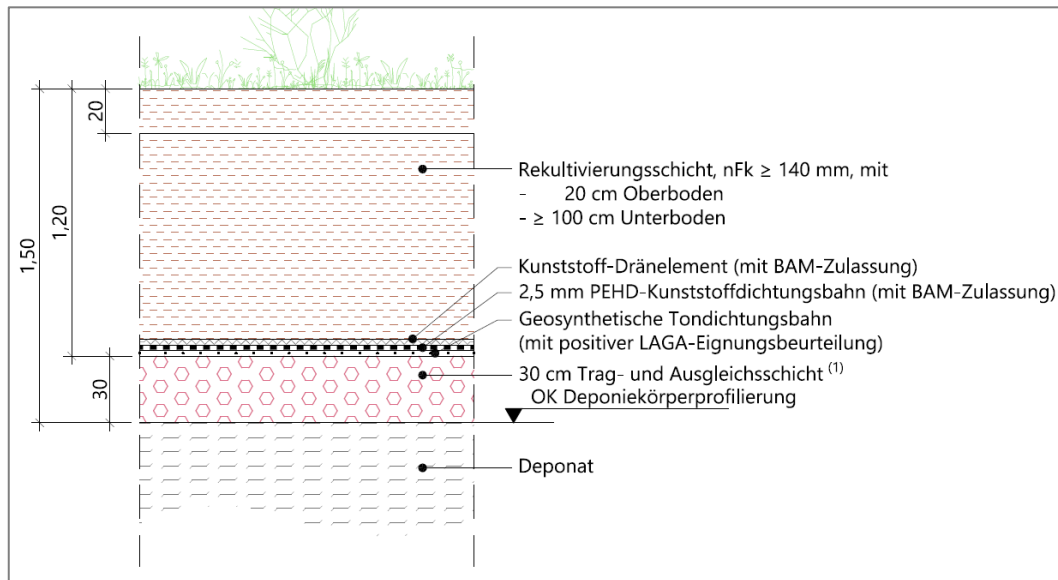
Oberflächenabdichtungssystem 1. und 2. BA (siehe auch Plan GP405, Anlage 3)
